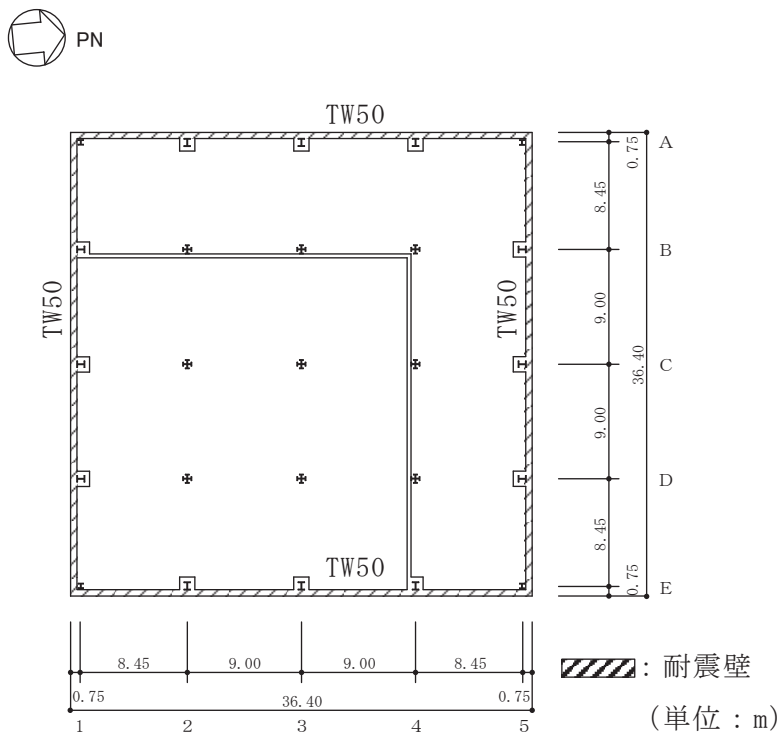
(4) 評価対象とする耐震壁 (2F, 0.P. 69. 4m)
